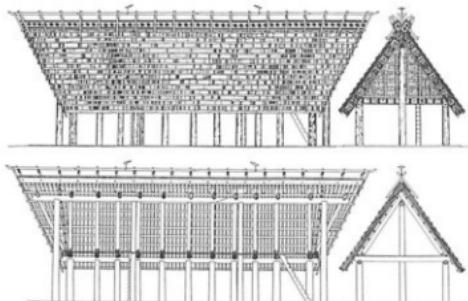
(左) 大型掘立柱建物の復原立面図(上)と復原断面図(下)
